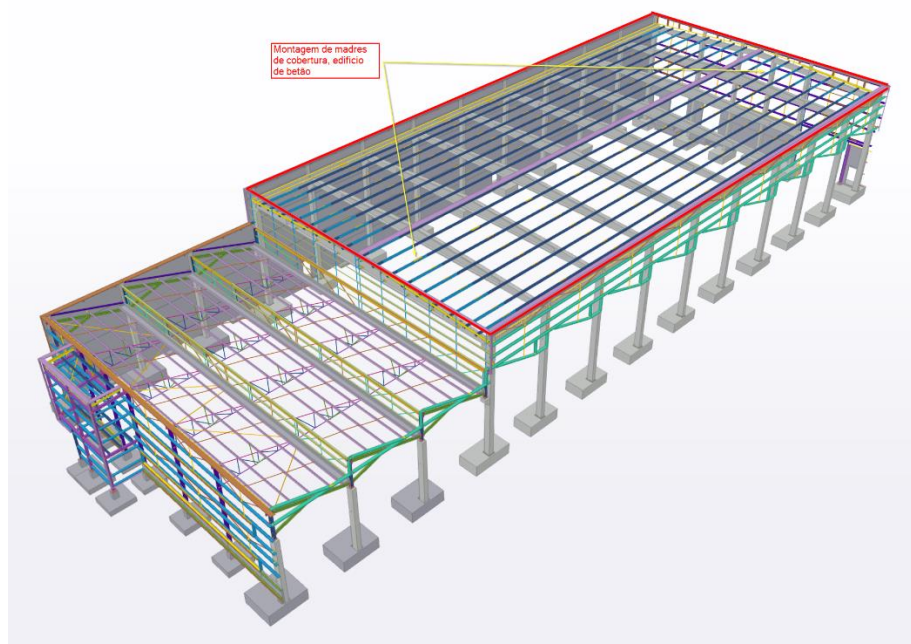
Vista 3D da estrutura em betão armado com as madres
